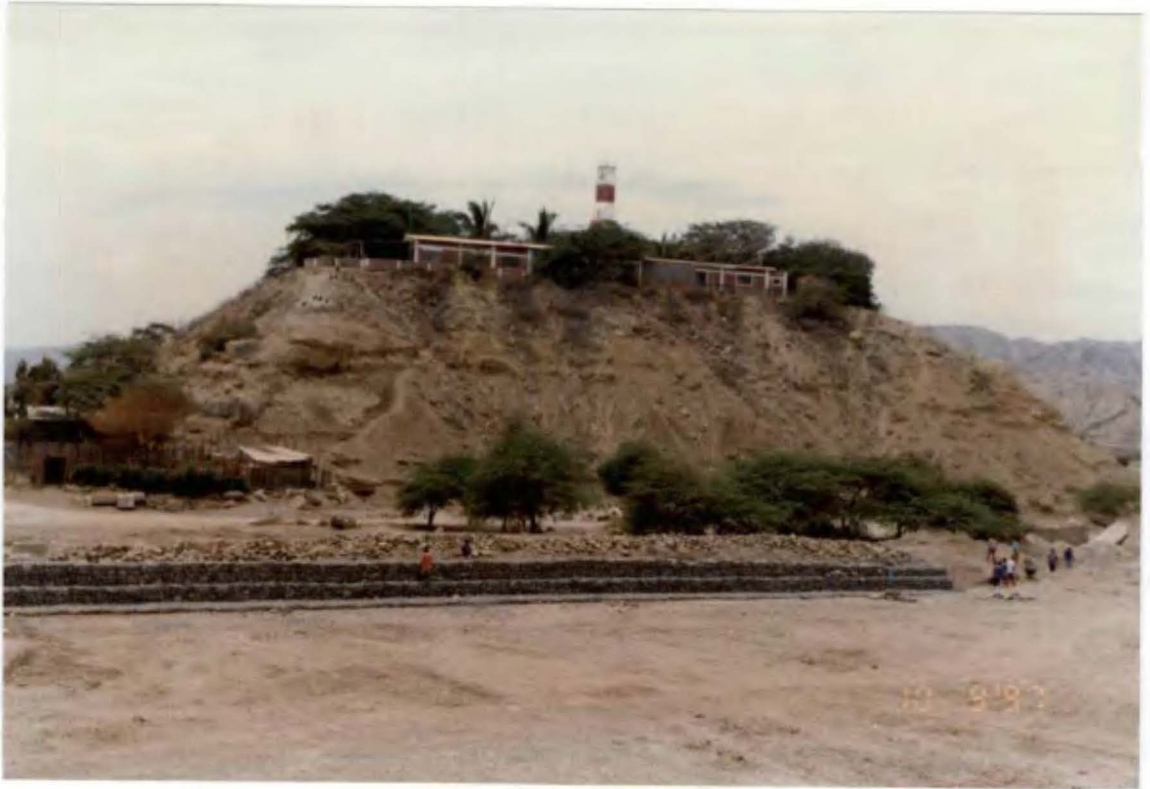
Muro de gaviones en construcción en la quebrada Cabo Blanco, así mismo se ha limpiado el cauce de la quebrada.
